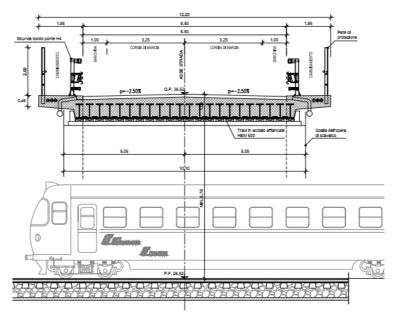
Cavalcaferrovia NW02 – Sezione trasversale impalcato
